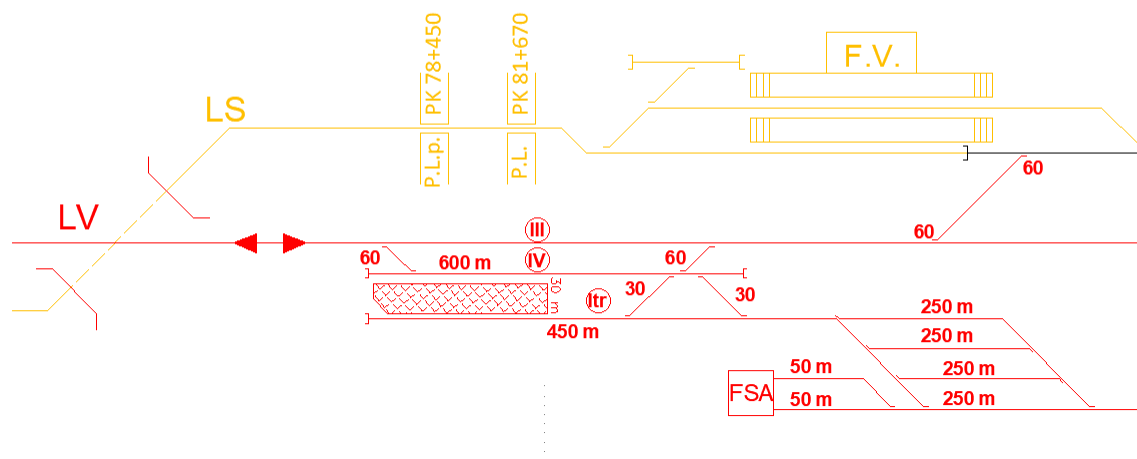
Layout funzionale di progetto – Nuovo PM Marcatobianco
